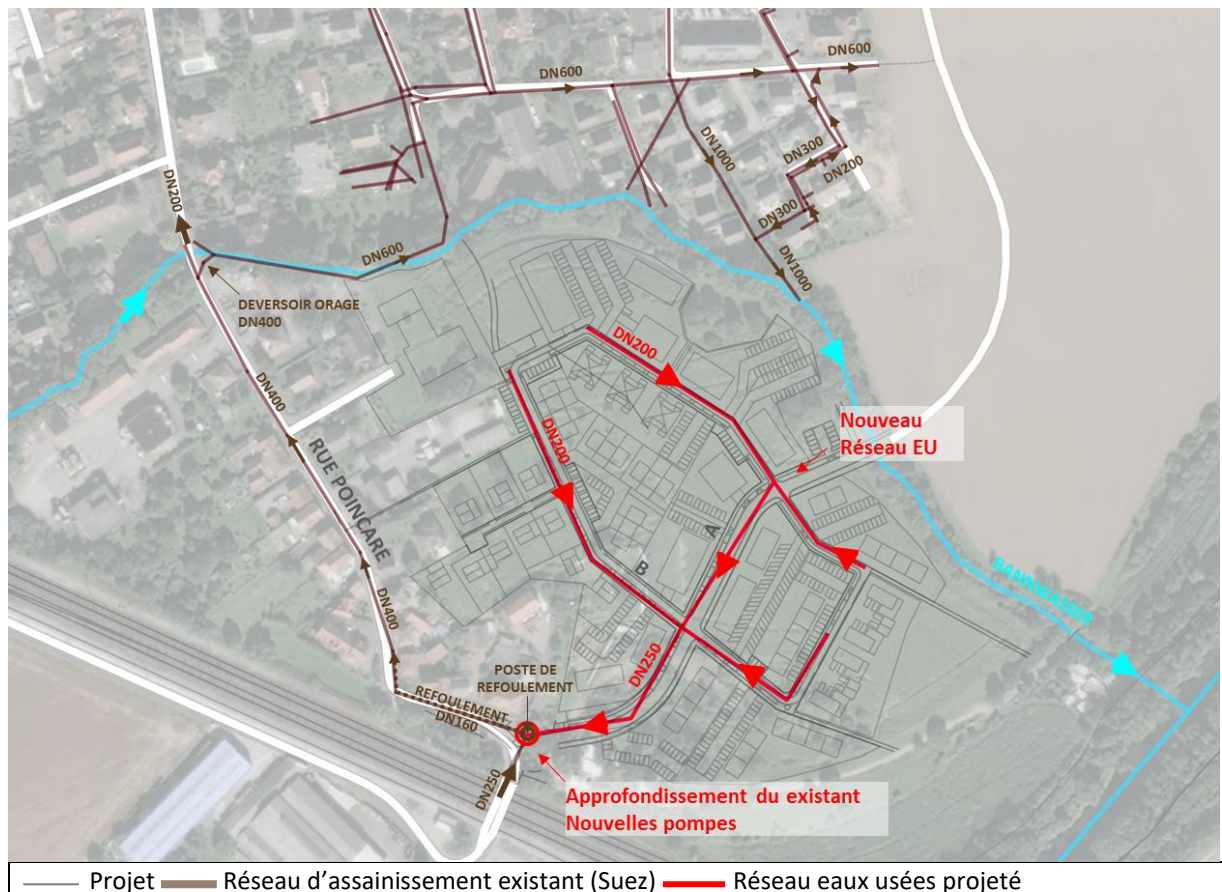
Plan de principe du nouveau réseau d'eaux usées
